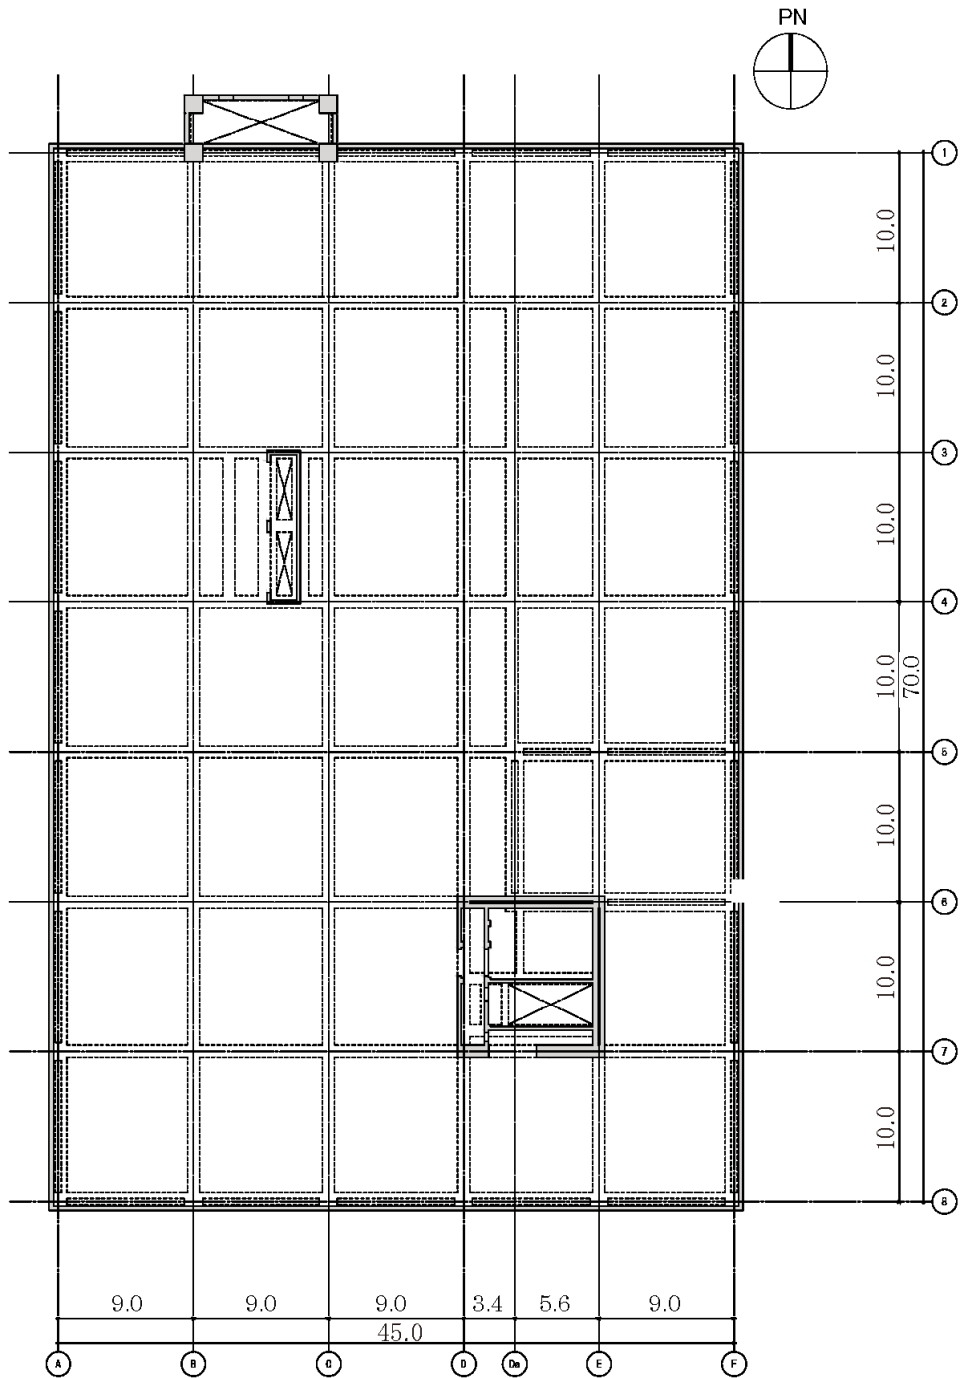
屋上階平面図 (G. L. +24.30) (单位 : m)
